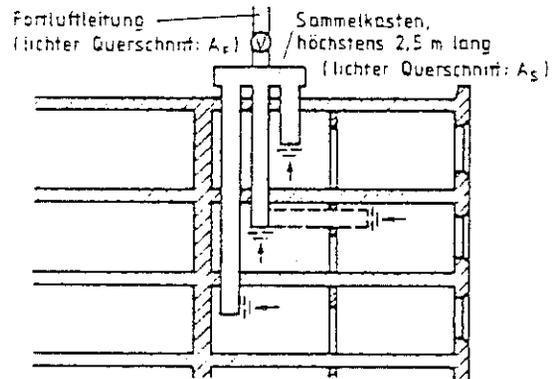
Zentrallüftungsanlage nach DIN 18017 Teil 3 mit getrennten Hauptleitungen
